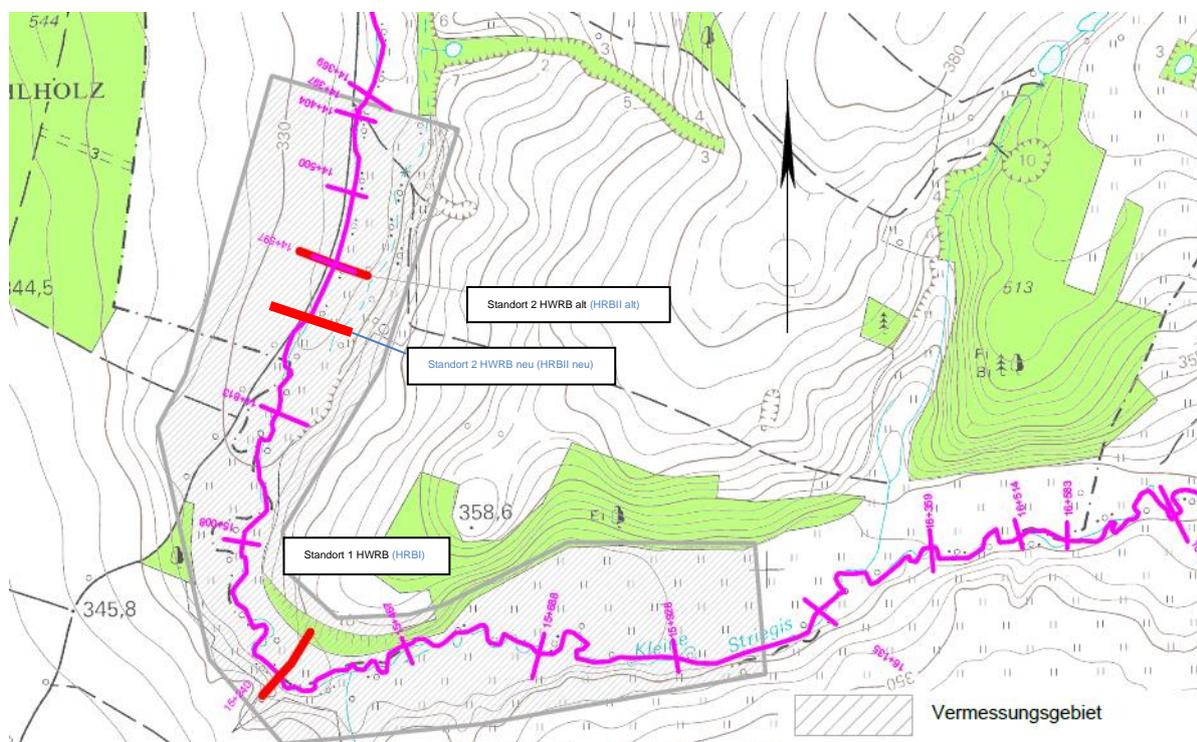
Lageplan der alternativen Beckenstandorte I, II alt und II neu
